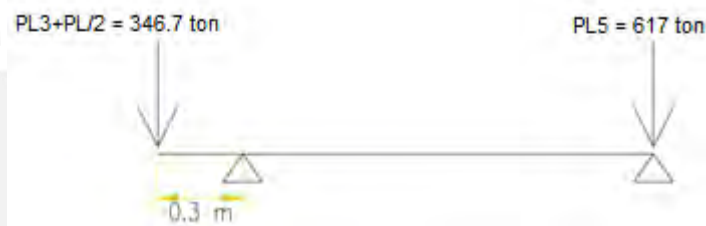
Cargas sobre la viga de cimentación VC-03.
